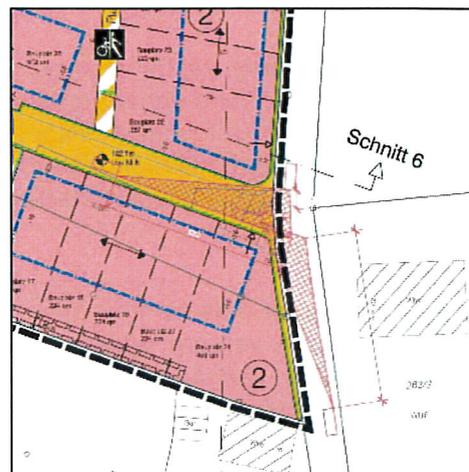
Sichtfelder Planstraße 2 und Oberweierer Straße
